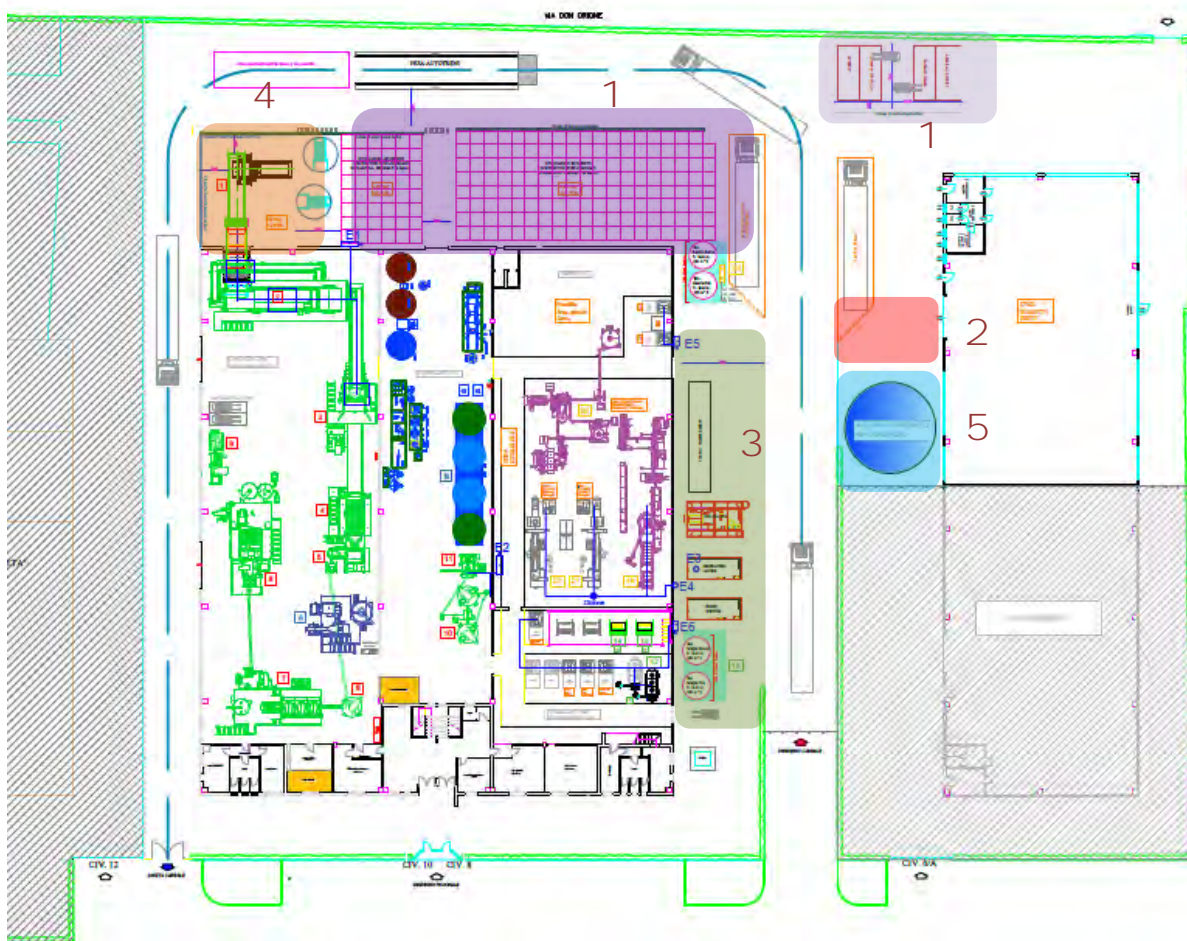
Planimetria stato di progetto – Layout generale del nuovo impianto
